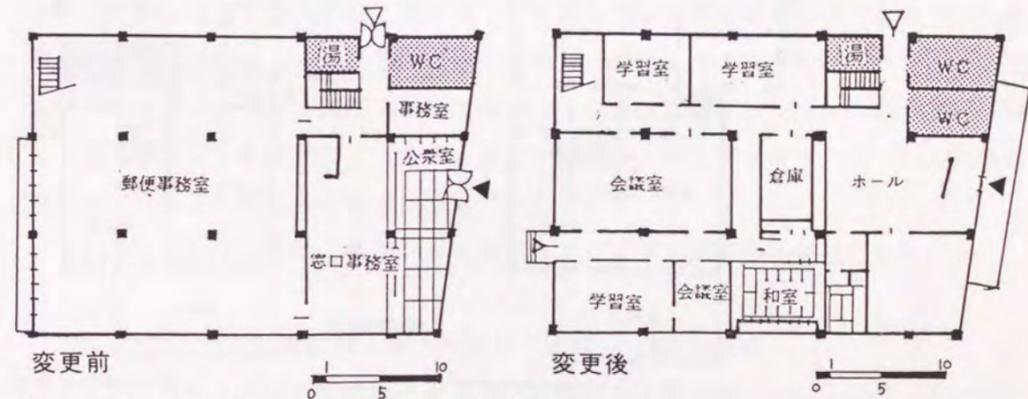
<83>所沢中央公民館(旧郵便局)1階平面図
